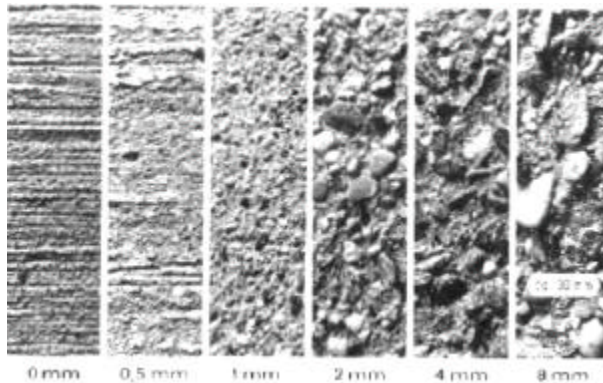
Oberflächenansichten eines Betons mit Abtragstiefen bis 8 mm [131]
